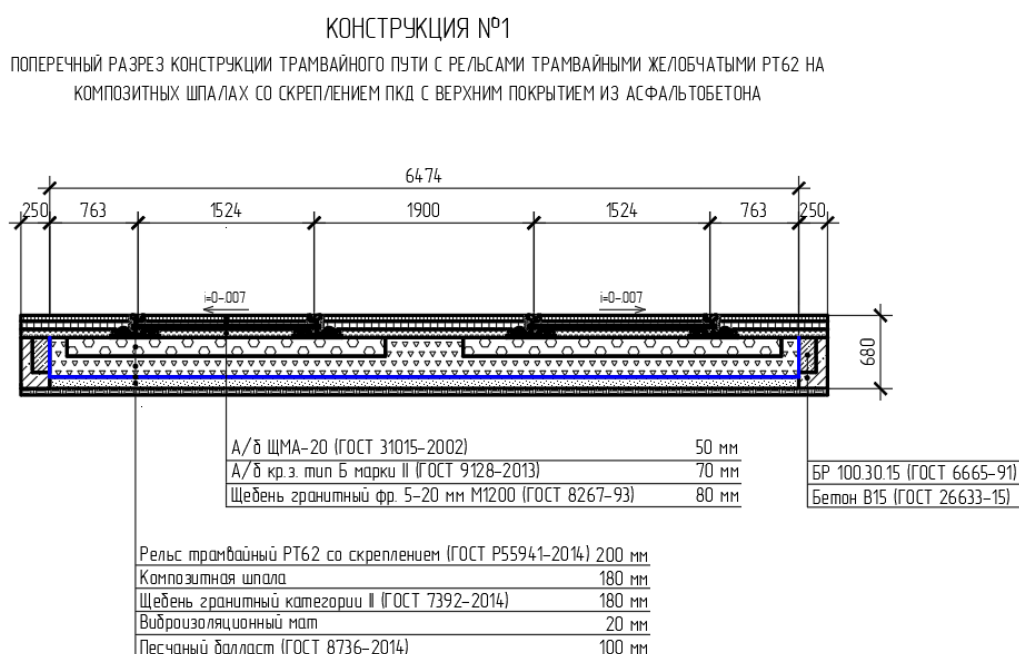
Поперечный разрез конструкции трамвайных путей с рельсами РТ-62 и с верхним покрытием из асфальтобетона
